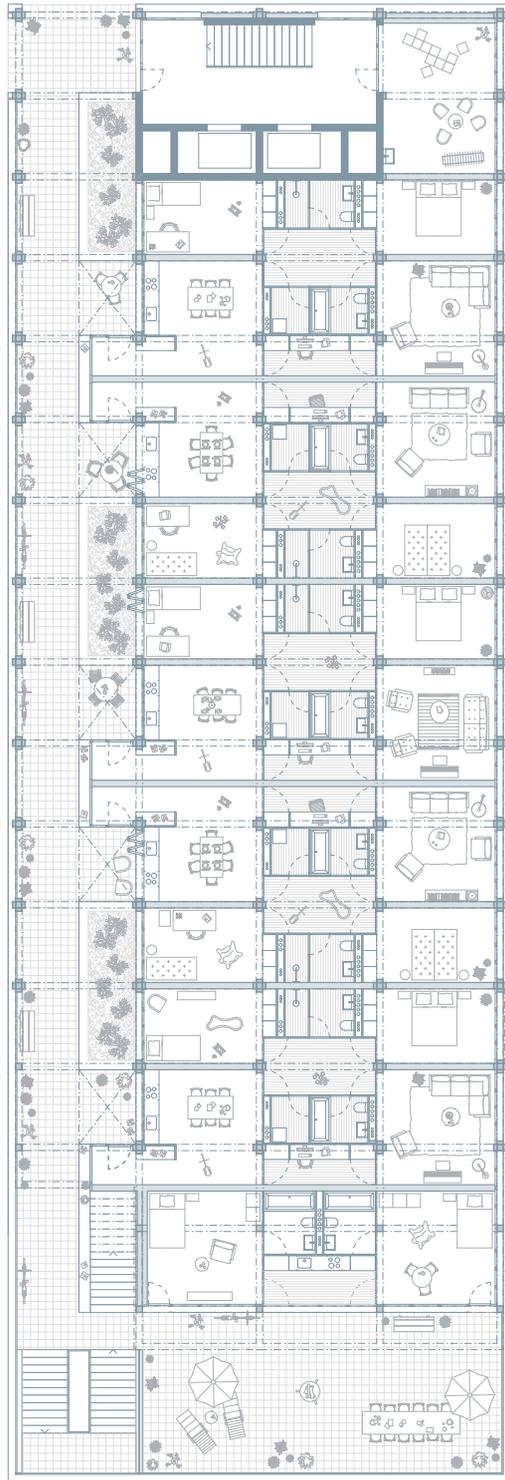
Grundriss des Wohnhaus, 2. Obergeschoss
